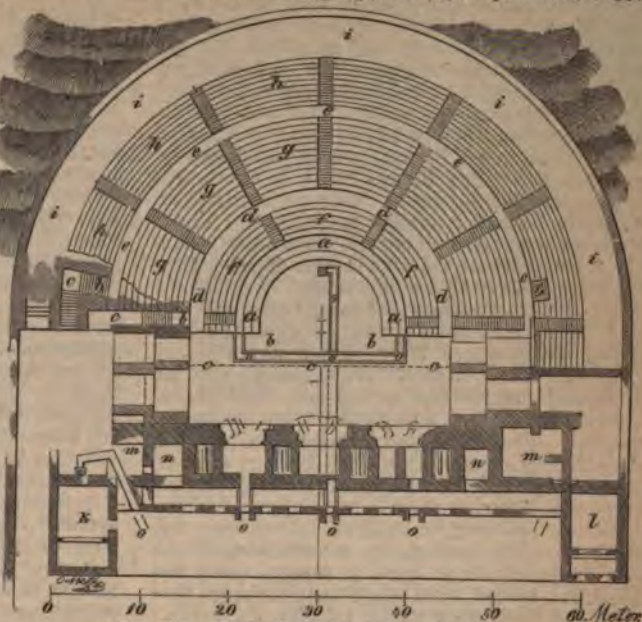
Grundriss des Theaters von Sagunt,
